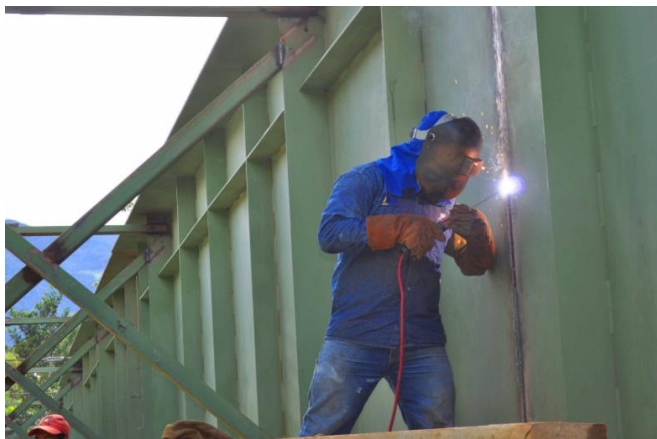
Planta de fabricación, aledaño a la posición final del puente
